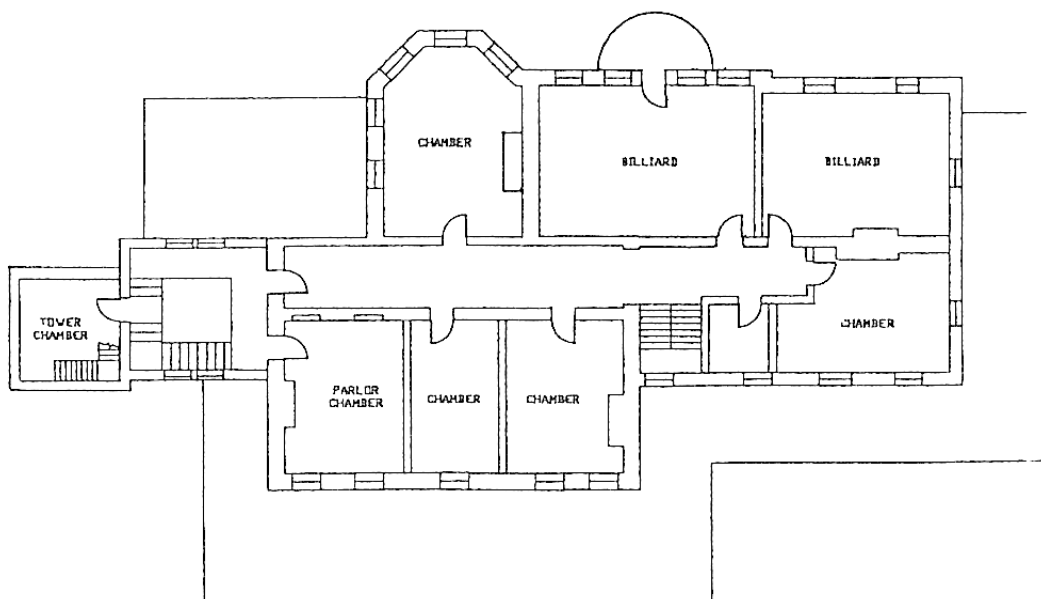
Grundriss im ersten Obergeschoss (1852) o.M.
